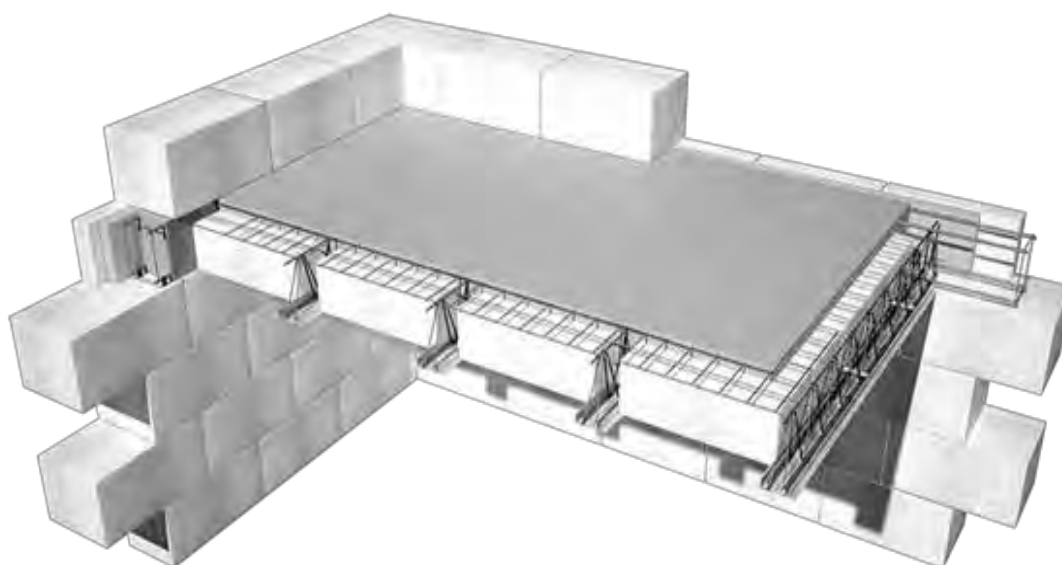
Плита перекрытия при использовании балок с арматурным каркасом
